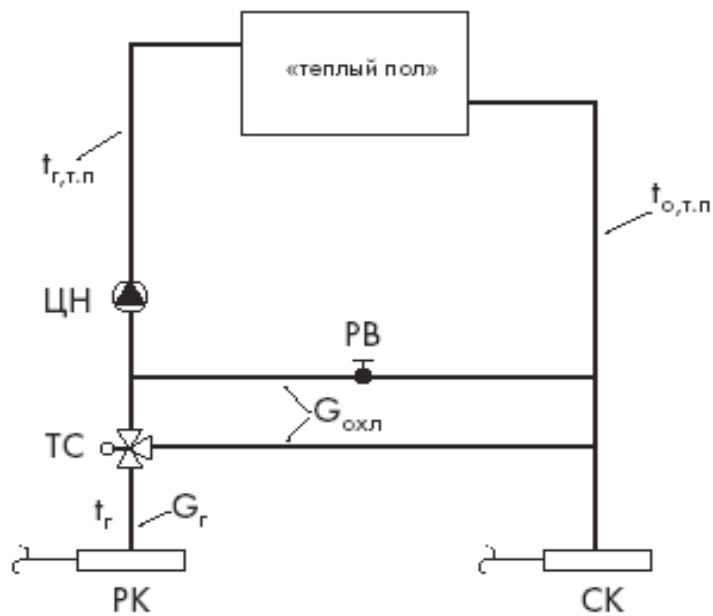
Схема узла подключения системы напольного отопления к общей схеме теплоснабжения здания
